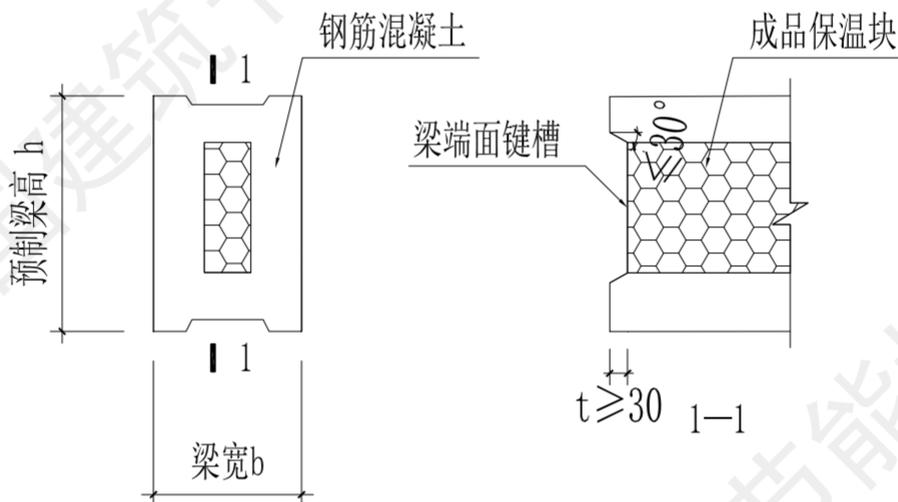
预制自保温叠合连梁梁端键槽构造示意
